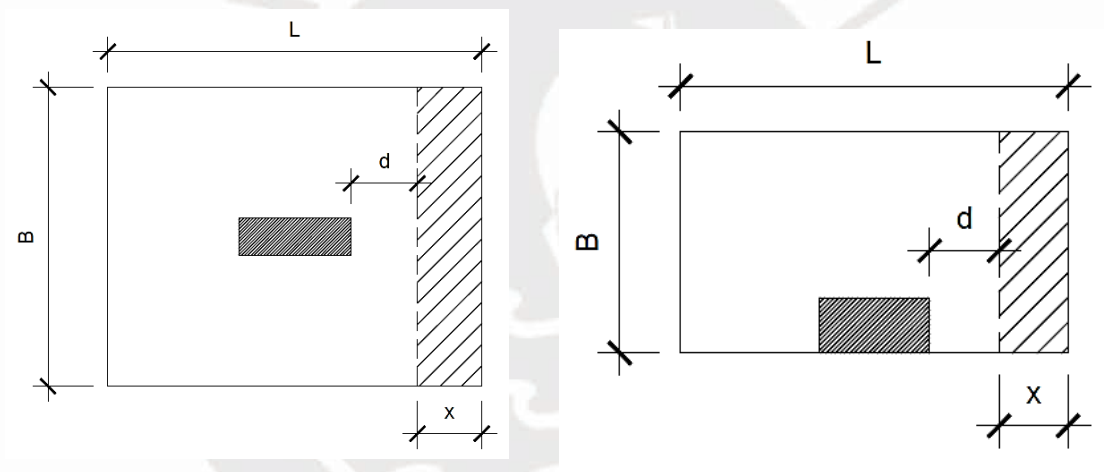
Esquema típico de sección crítica en zapatas aisladas y laterales – diseño por corte
